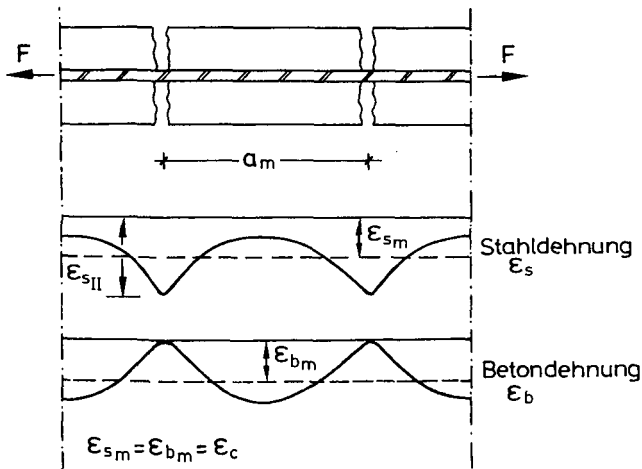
Gerissener Stahlbetonstab unter Zugbeanspruchung
